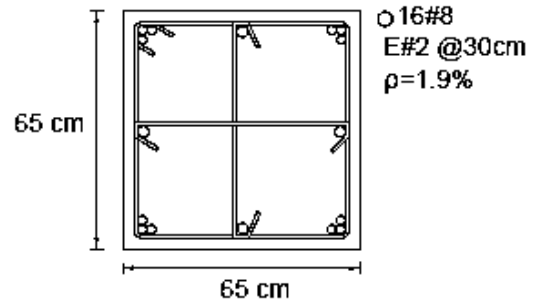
Armado de vigas y columnas del edificio de 8 niveles diseñado con las NTCS-76 con un Q igual a 6
